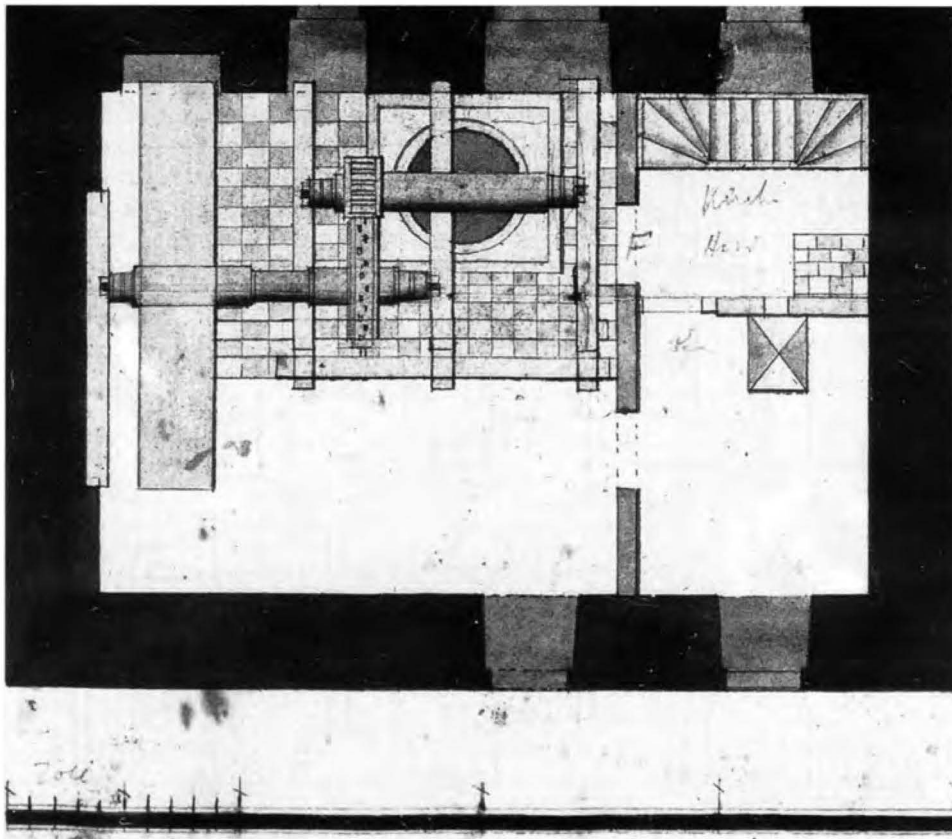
Breisach, Radbrunnenturm. Plan zum Wiederaufbau des Neumüllers Schindler, etwa 1825; zu beachten die Lage des Brunnens an der Westwand des Gebäudes. Grundriß. (StadtAF, L 1 Breisach, Akten Nr. 1238)
